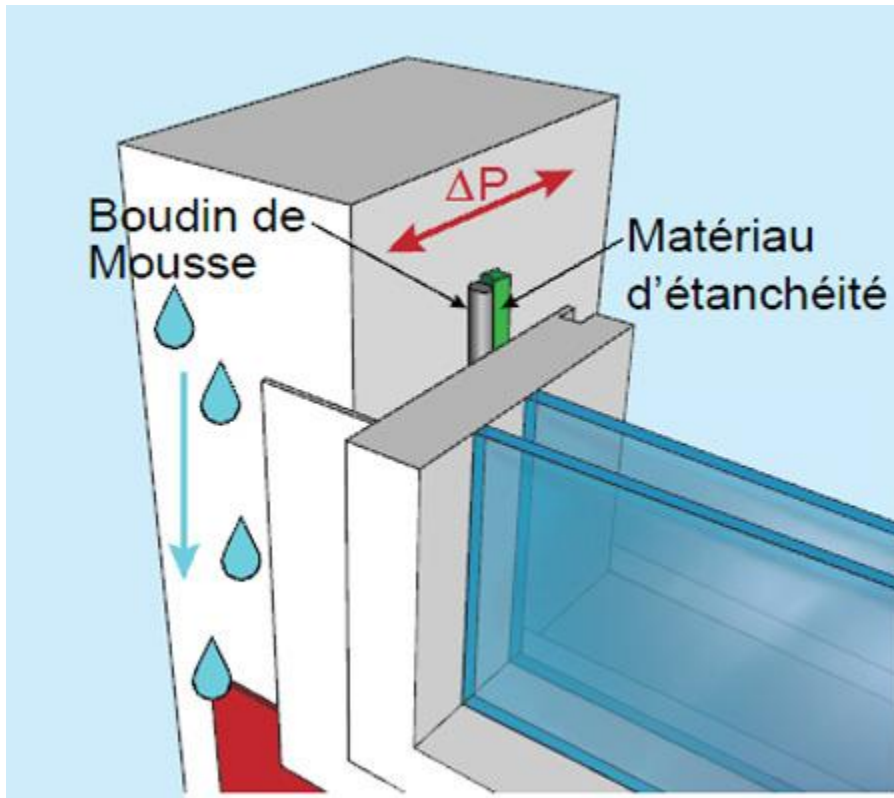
(b). Détail d'un montant de fenêtre montrant : que le déplacement du plan d'étanchéité à l'air vers l'intérieur réduit la force d'entraînement qui permet à l'eau de s'infiltrer au niveau de la bride.
